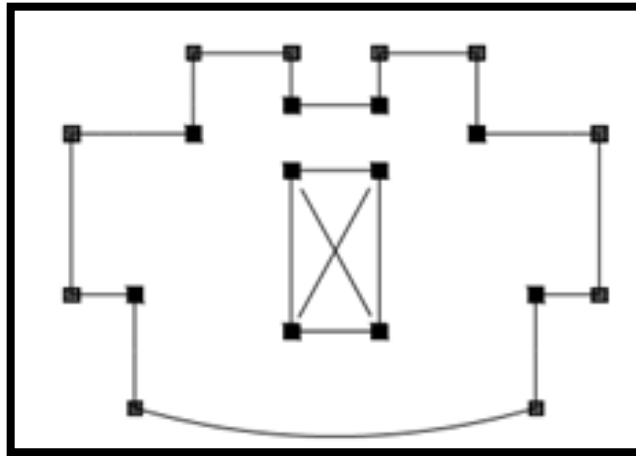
Incorporación de columnas en los vértices faltantes de la planta geométrica.
